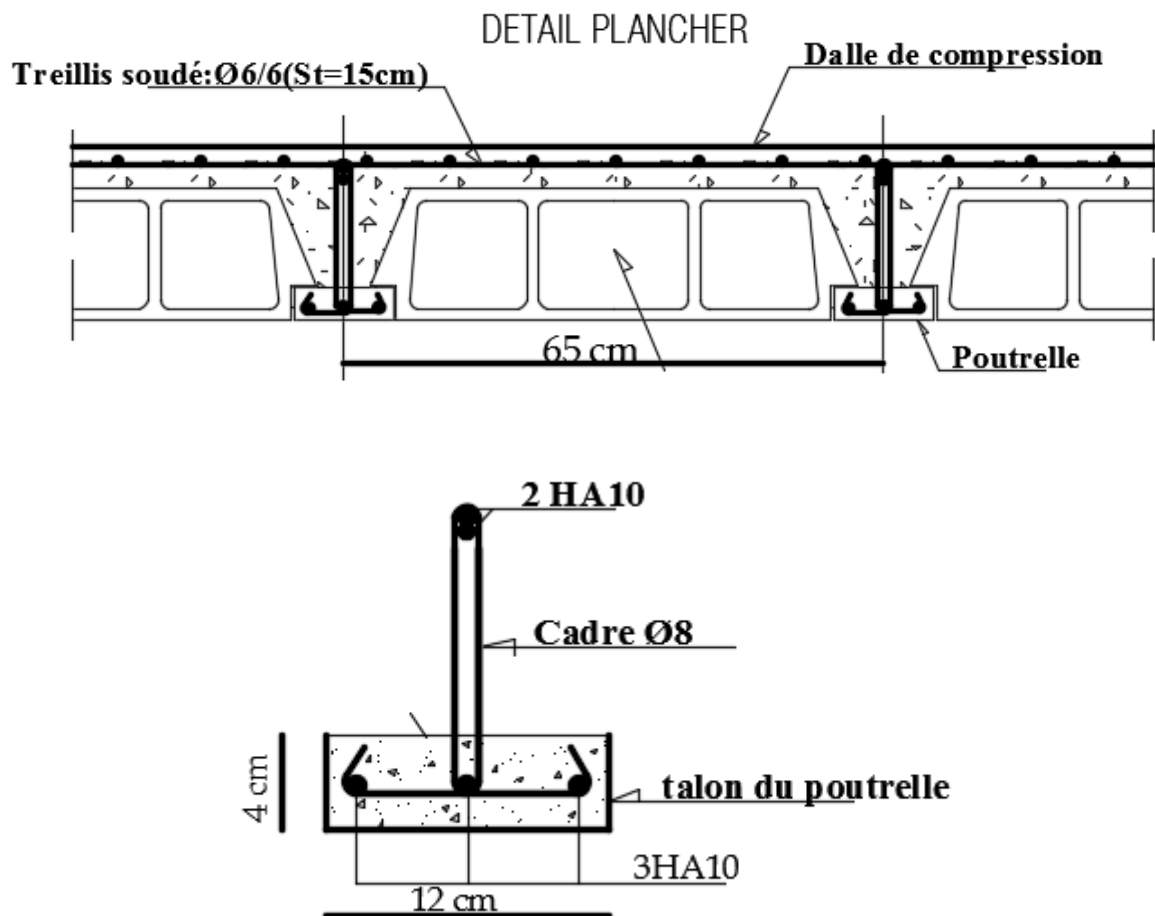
schema de ferrailage du plancher en corps creux.
